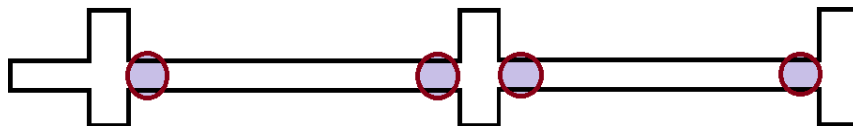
ubicación de las rotulas en las Vigas-20A; VIGA-20C, VIGA-20E Y VIGA-20G
